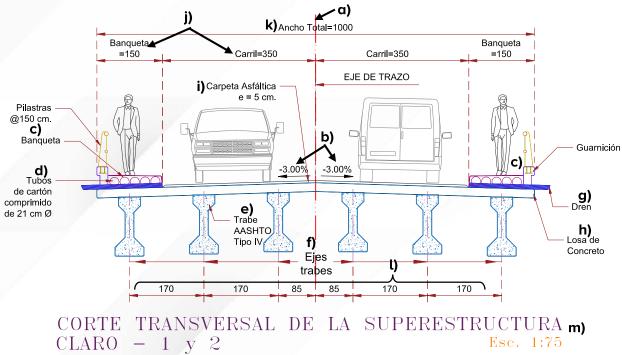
Ejemplo corte transversal de la superestructura (por claro)
